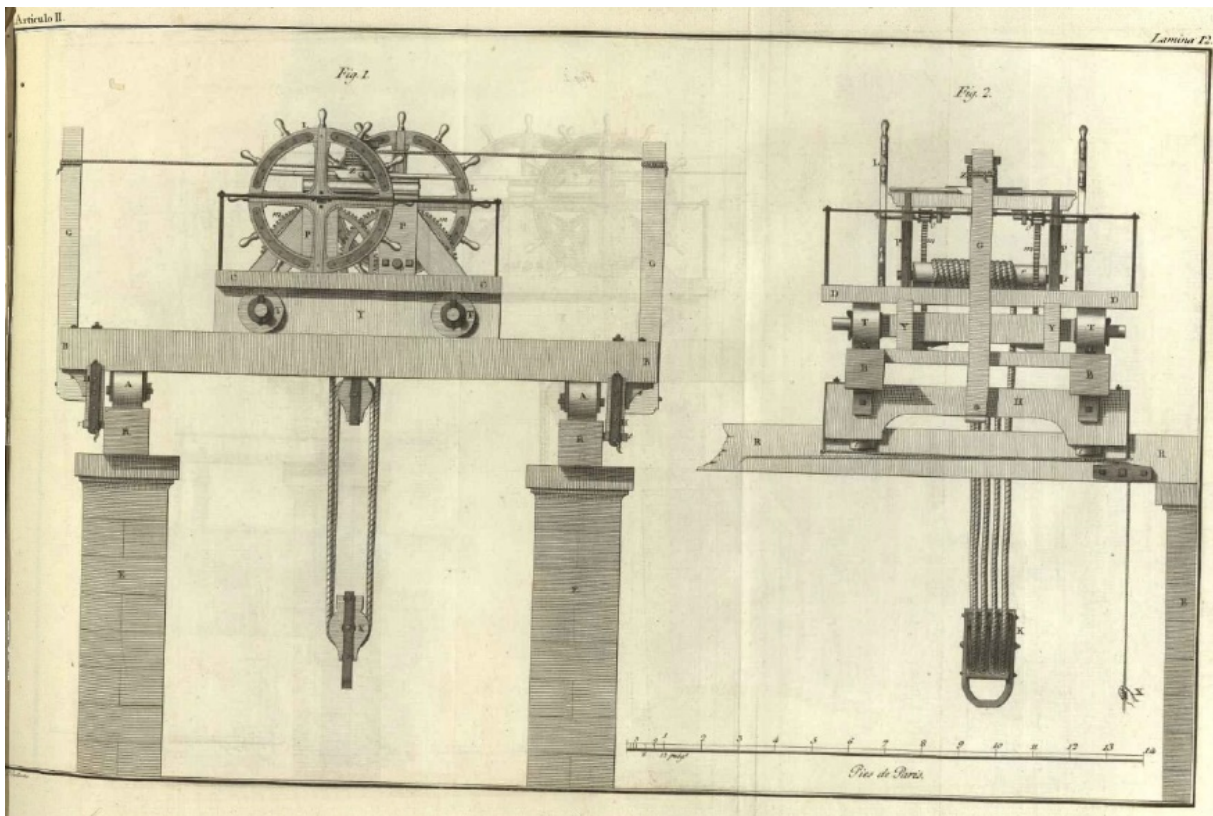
Plano con vistas de alzado y perfil del cabriolé doble [3].
